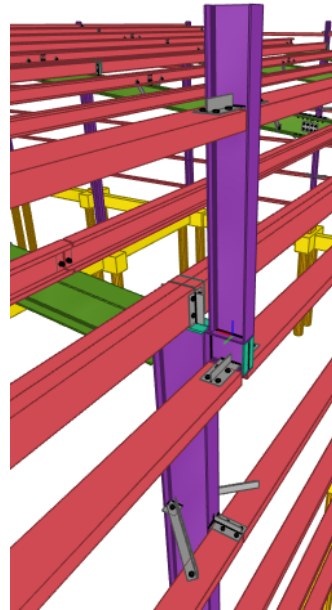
Detalle de encuentro entre bayoneta y columnas laterales. Fuente: Elaboración propia
